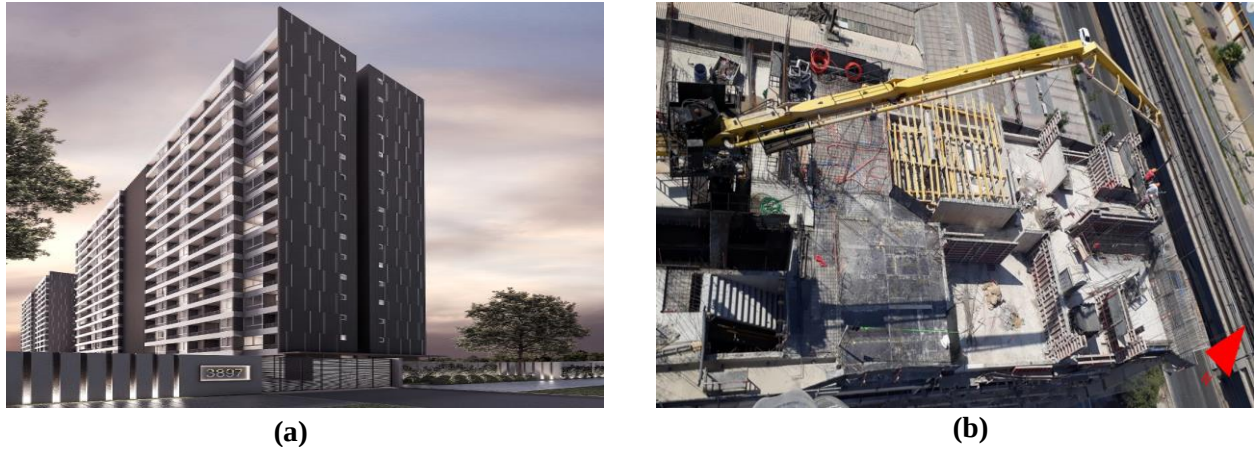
Edificio donde se realizó la investigación. (a) Fachada norte del edificio (b) Sección de planta etapa obra gruesa.
